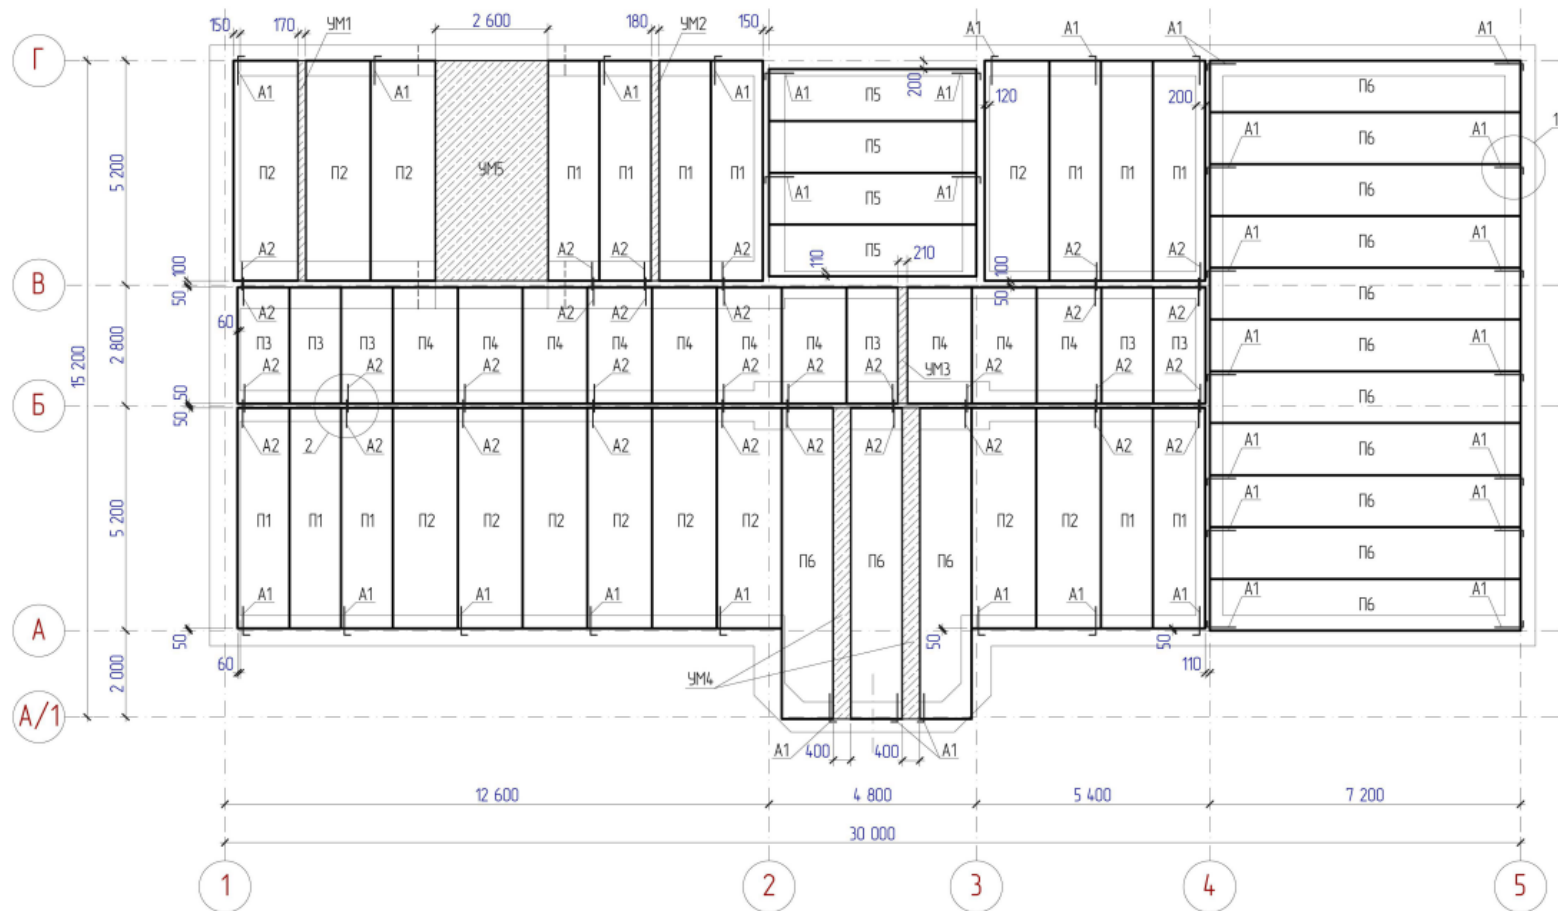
Схема расположения панелей цокольного перекрытия
